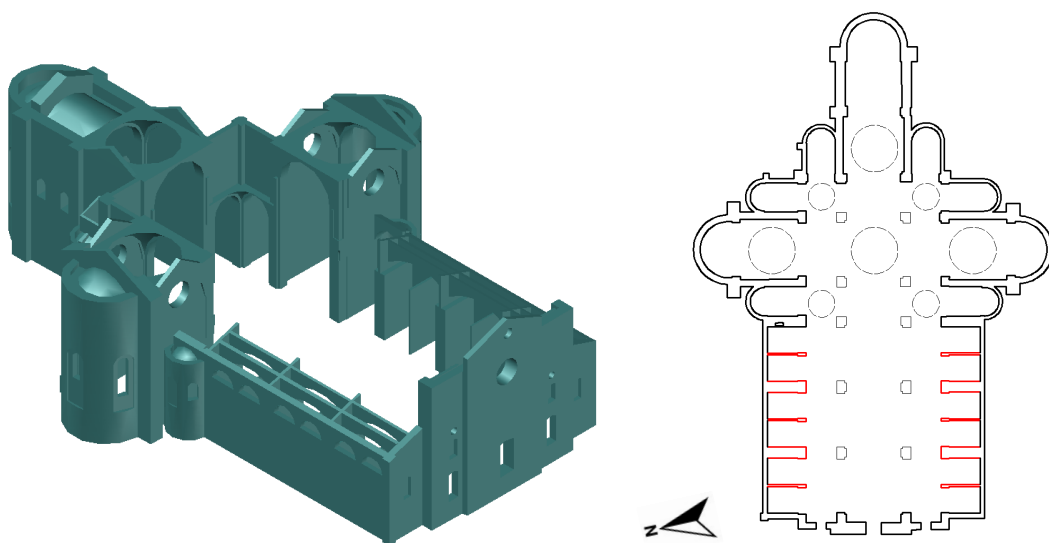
Vista assonometrica e pianta della fase 4 della struttura.
